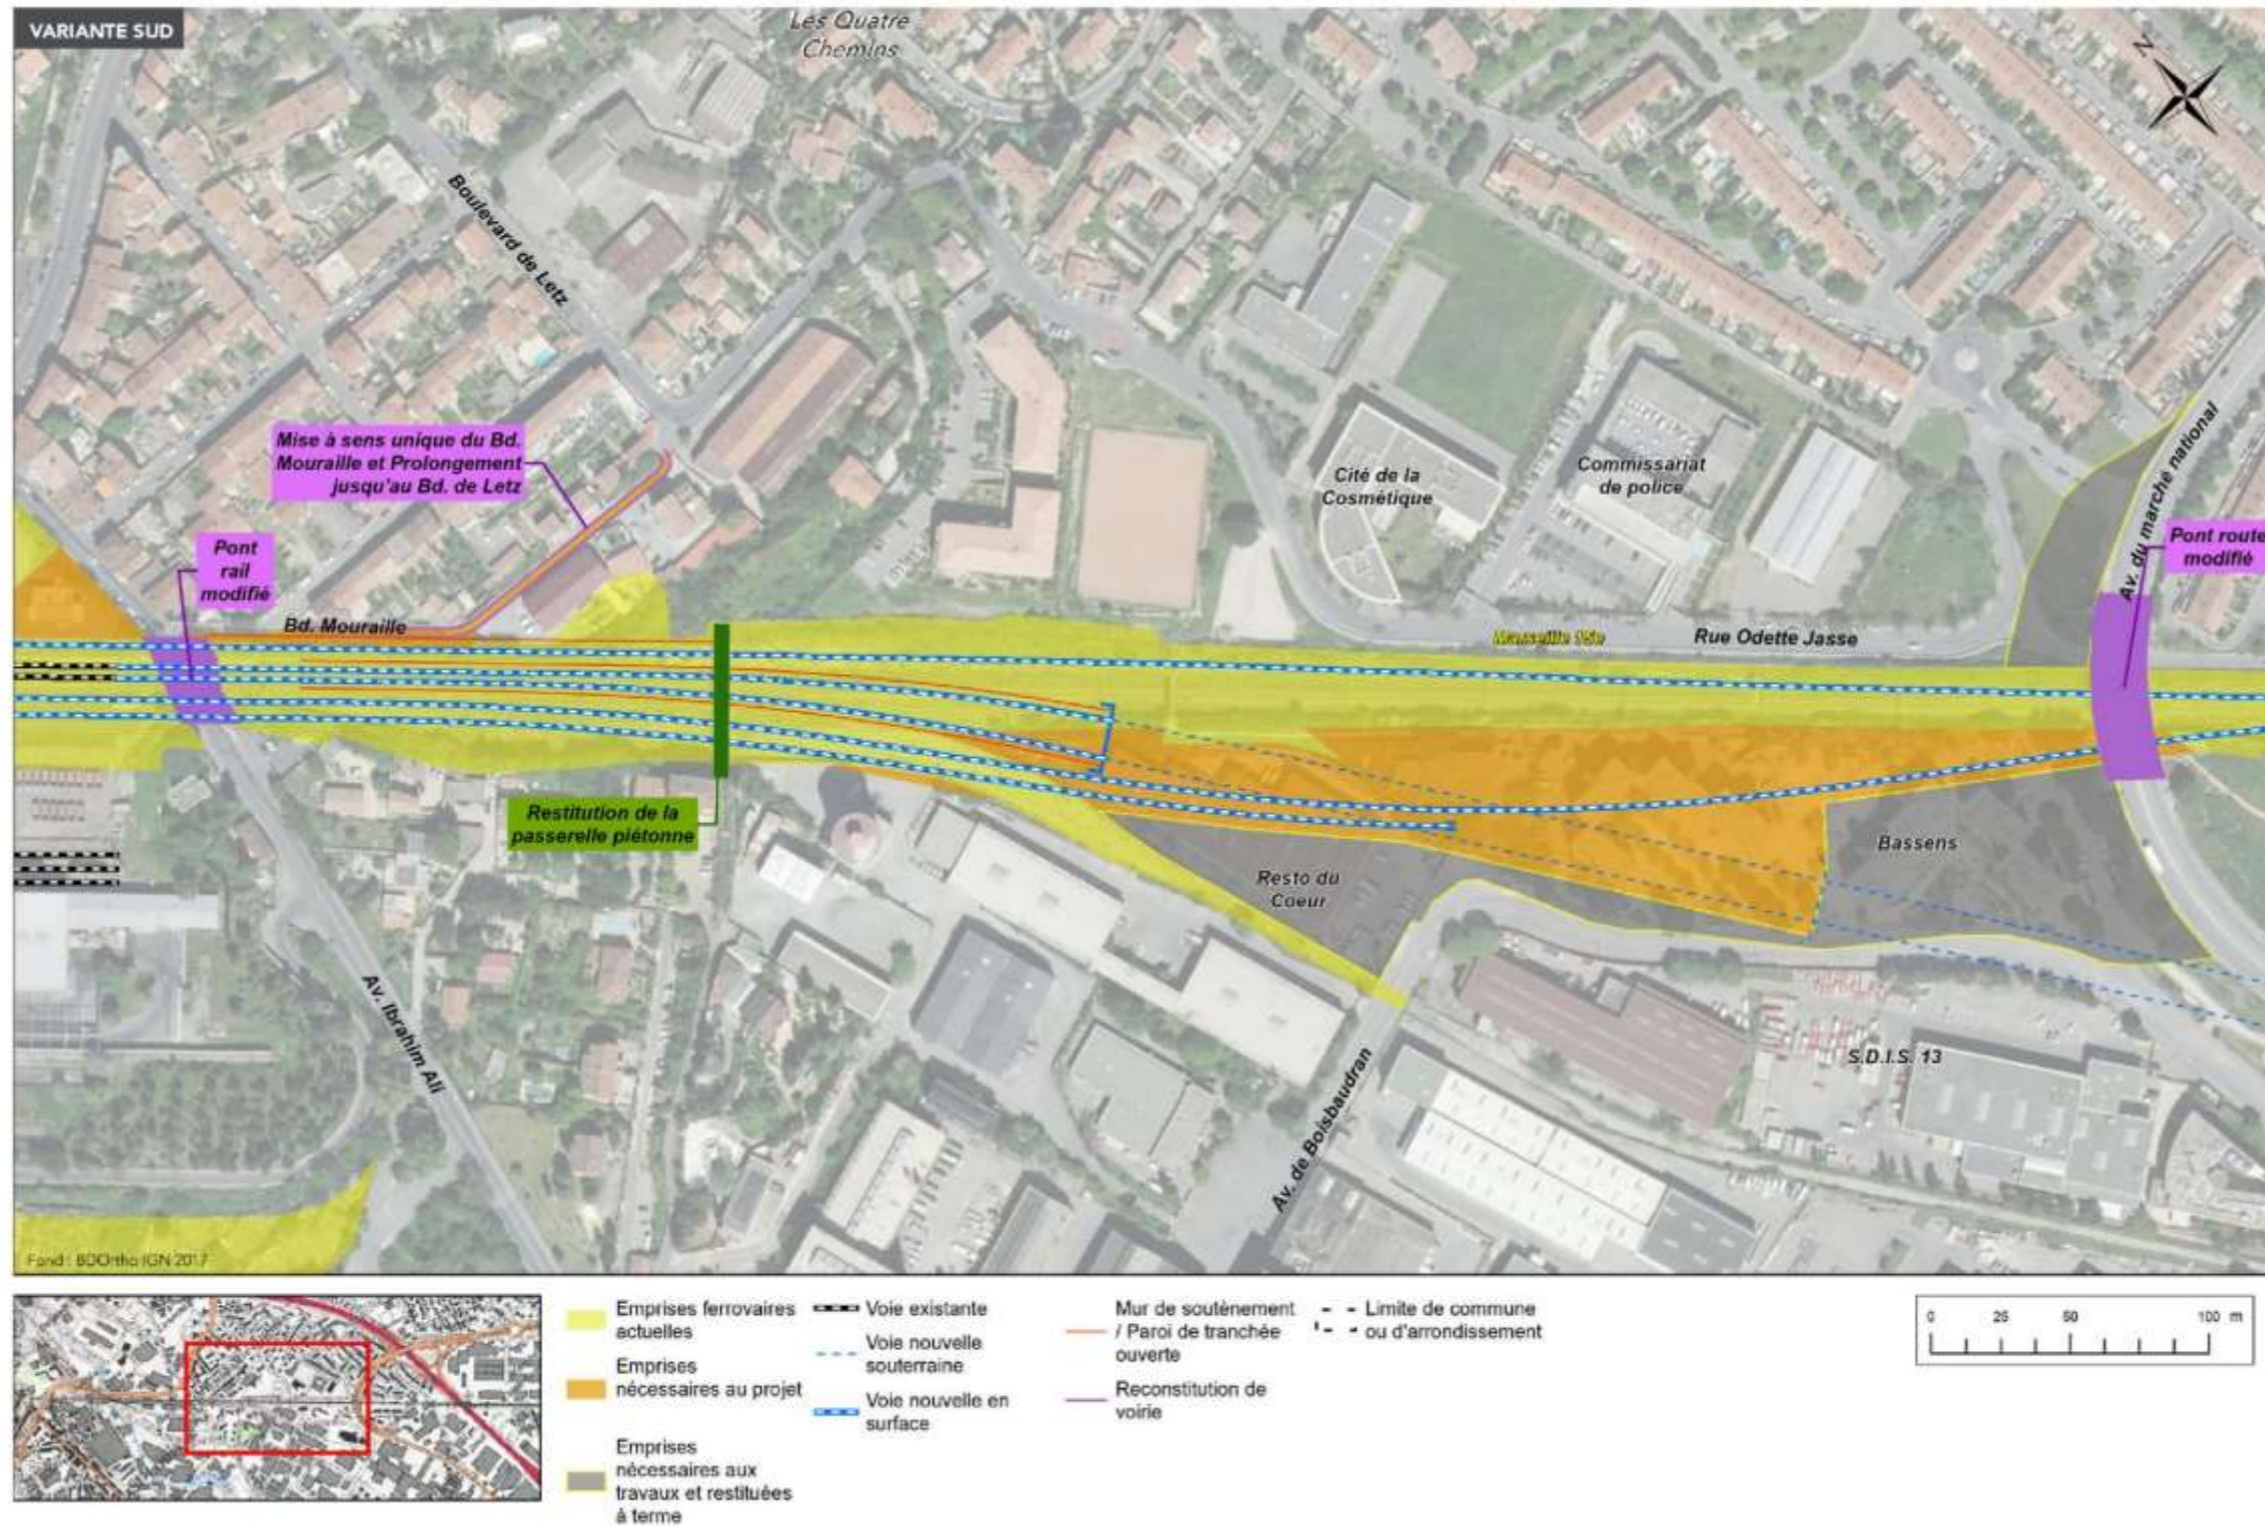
Variante sud 2/2 (dossier de concertation 2021 – La Delorme : entrée nord du tunnel de la gare Marseille Saint-Charles)
